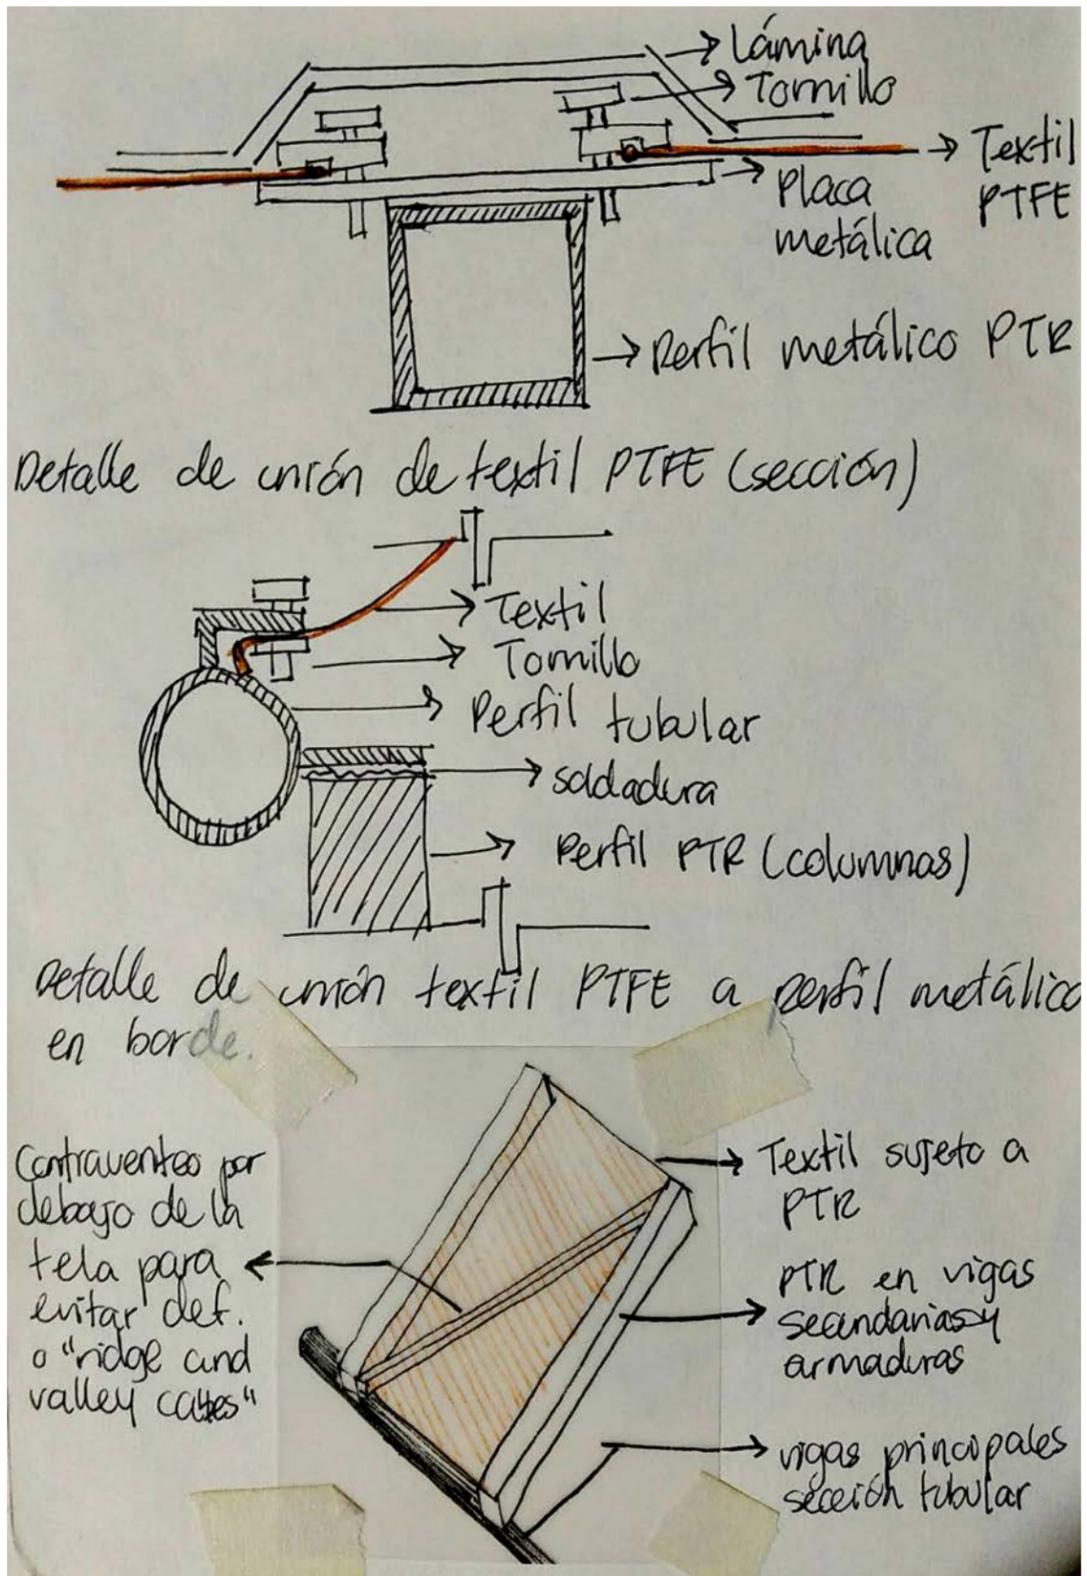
Croquis de estructura de cubierta. Elaboración propia.
